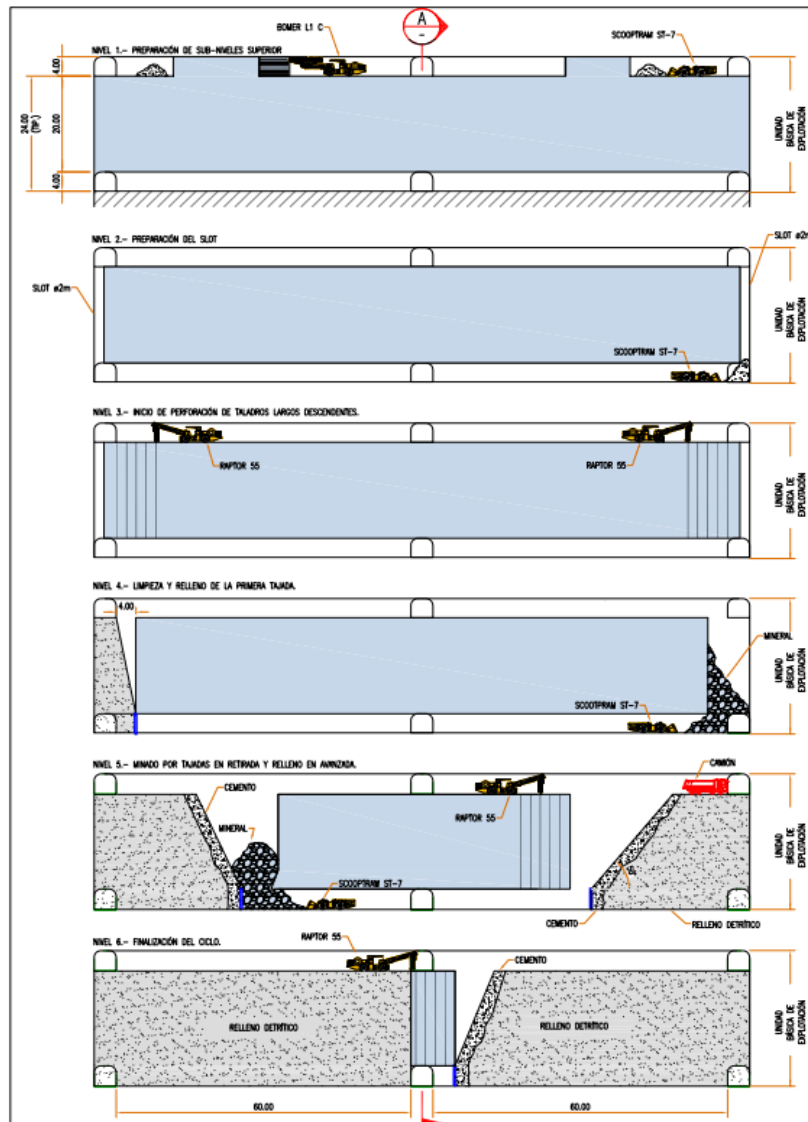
Vista longitudinal minado Bench and Fill (avoca) con relleno Detritico.
